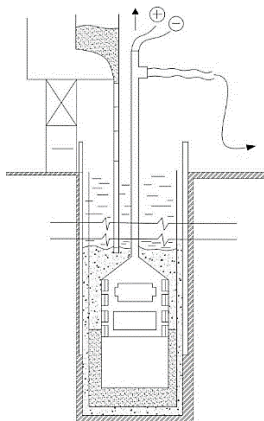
Технологическая схема возведение буронабивной сваи-оболочки в неустойчивых грунтах
